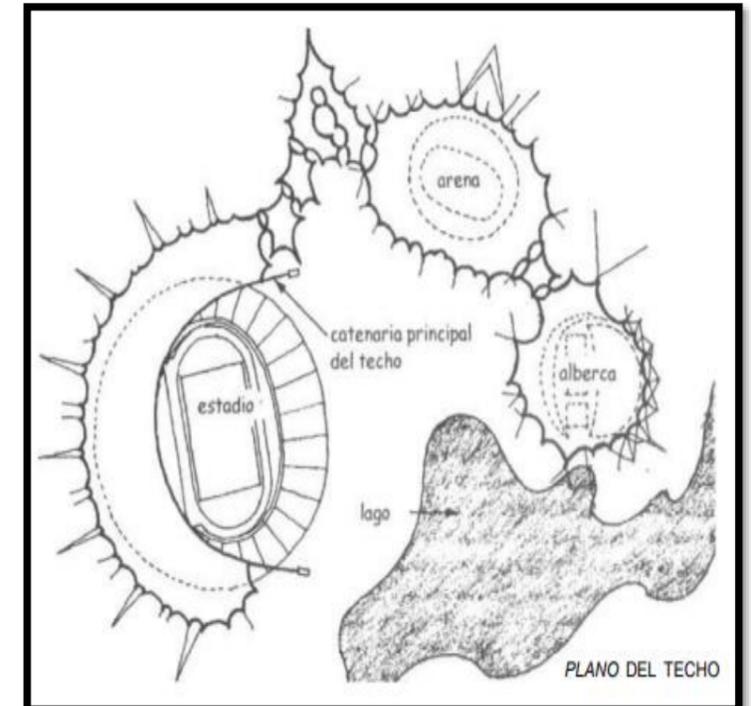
Plano de Techo del Estadio Olímpico de Múnich
